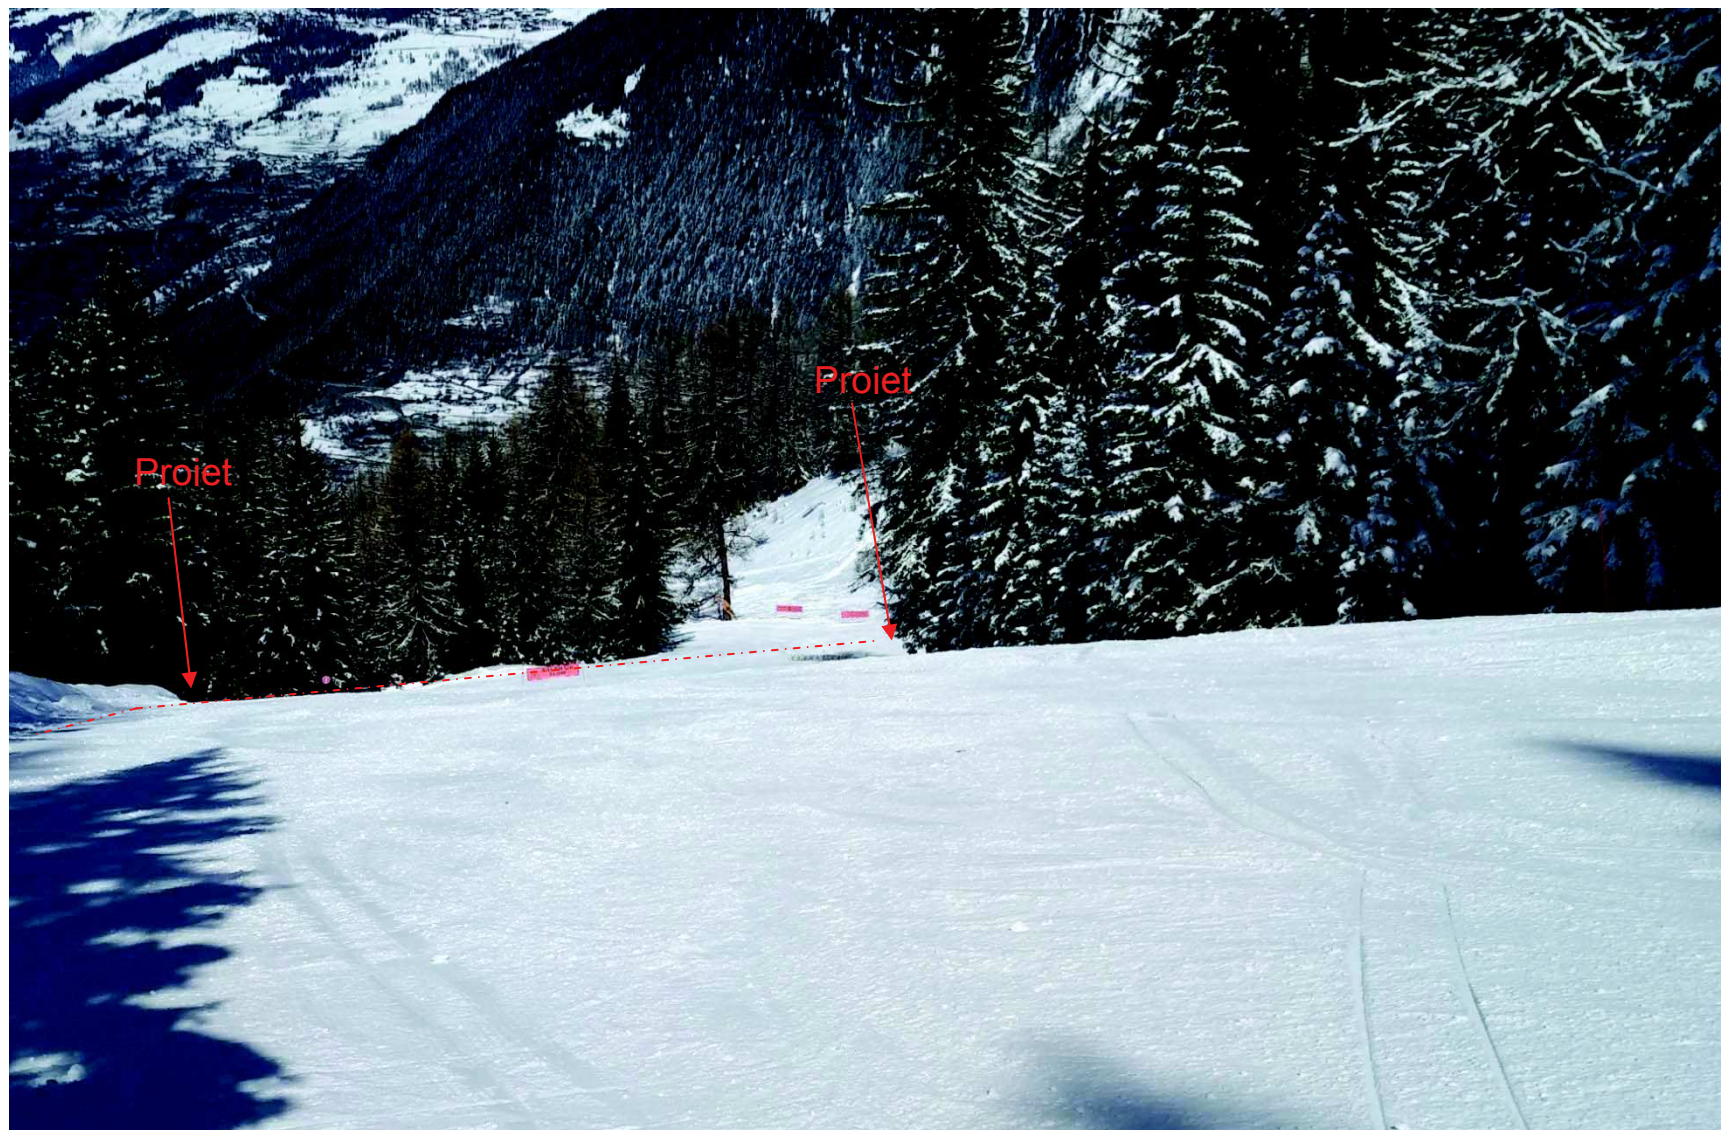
PHOTOS DE LA PISTE DE SKI DU CREUX DE FORMEIAN HAUT – PHOTO 4 (2019)
